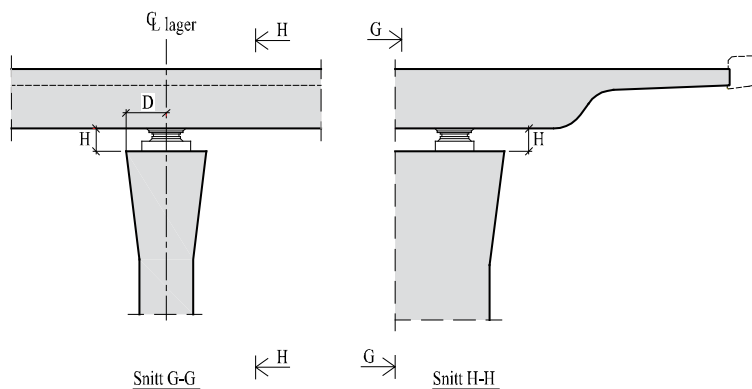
Krav til frihøyde ved lagre – 1 sidig tilk/ fastlager
